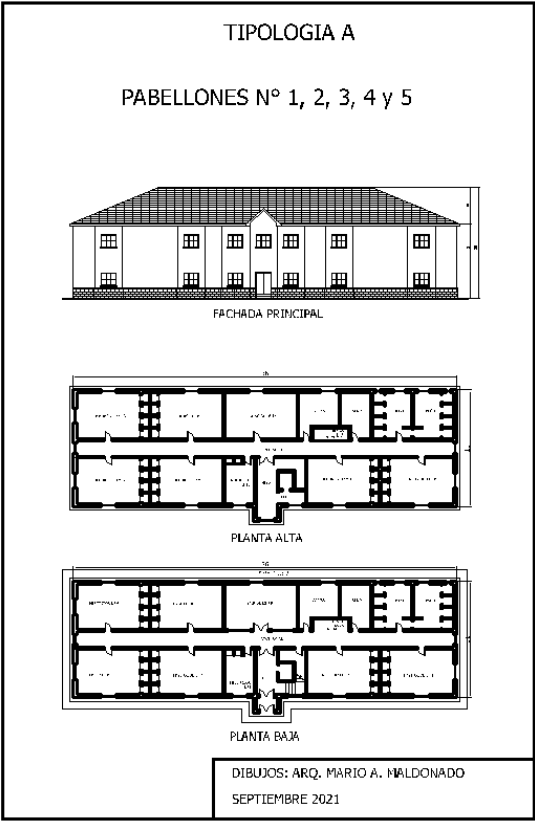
Vista y plantas del Pabellón tipo “A”. Elaboración: Arq. Mario Maldonado (2021).
